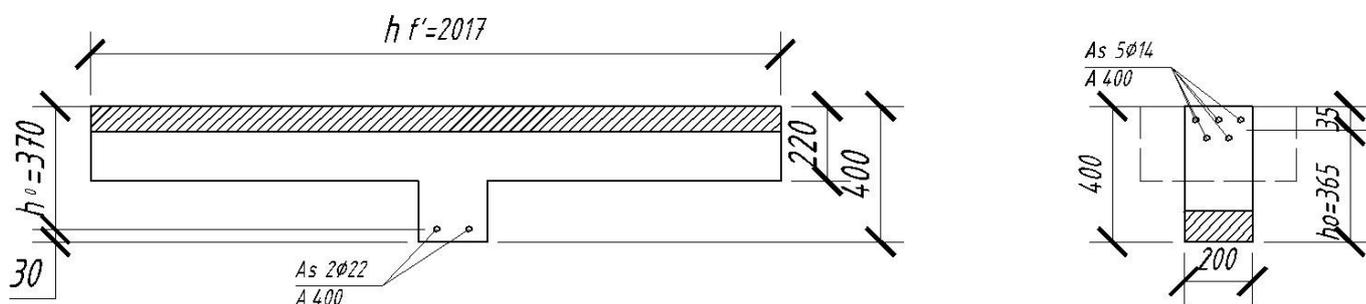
К расчету продольной арматуры в сечениях второстепенной балки
